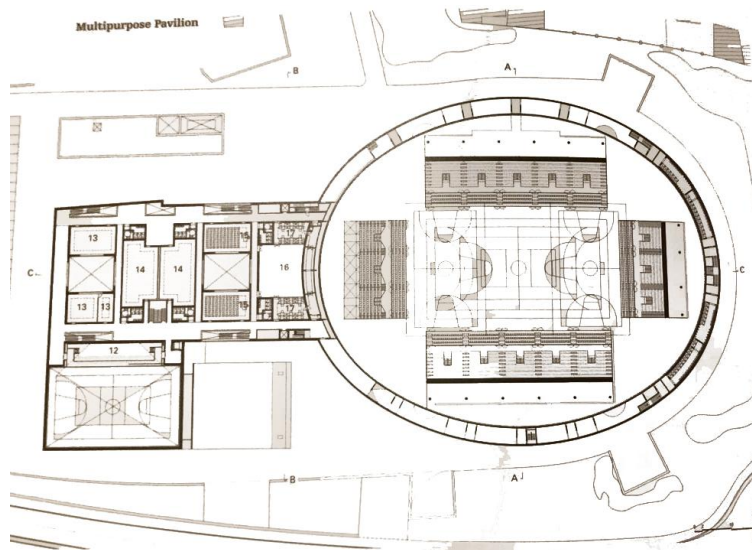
Plataforma Arquitectura. Planta Baja Gondomar.
